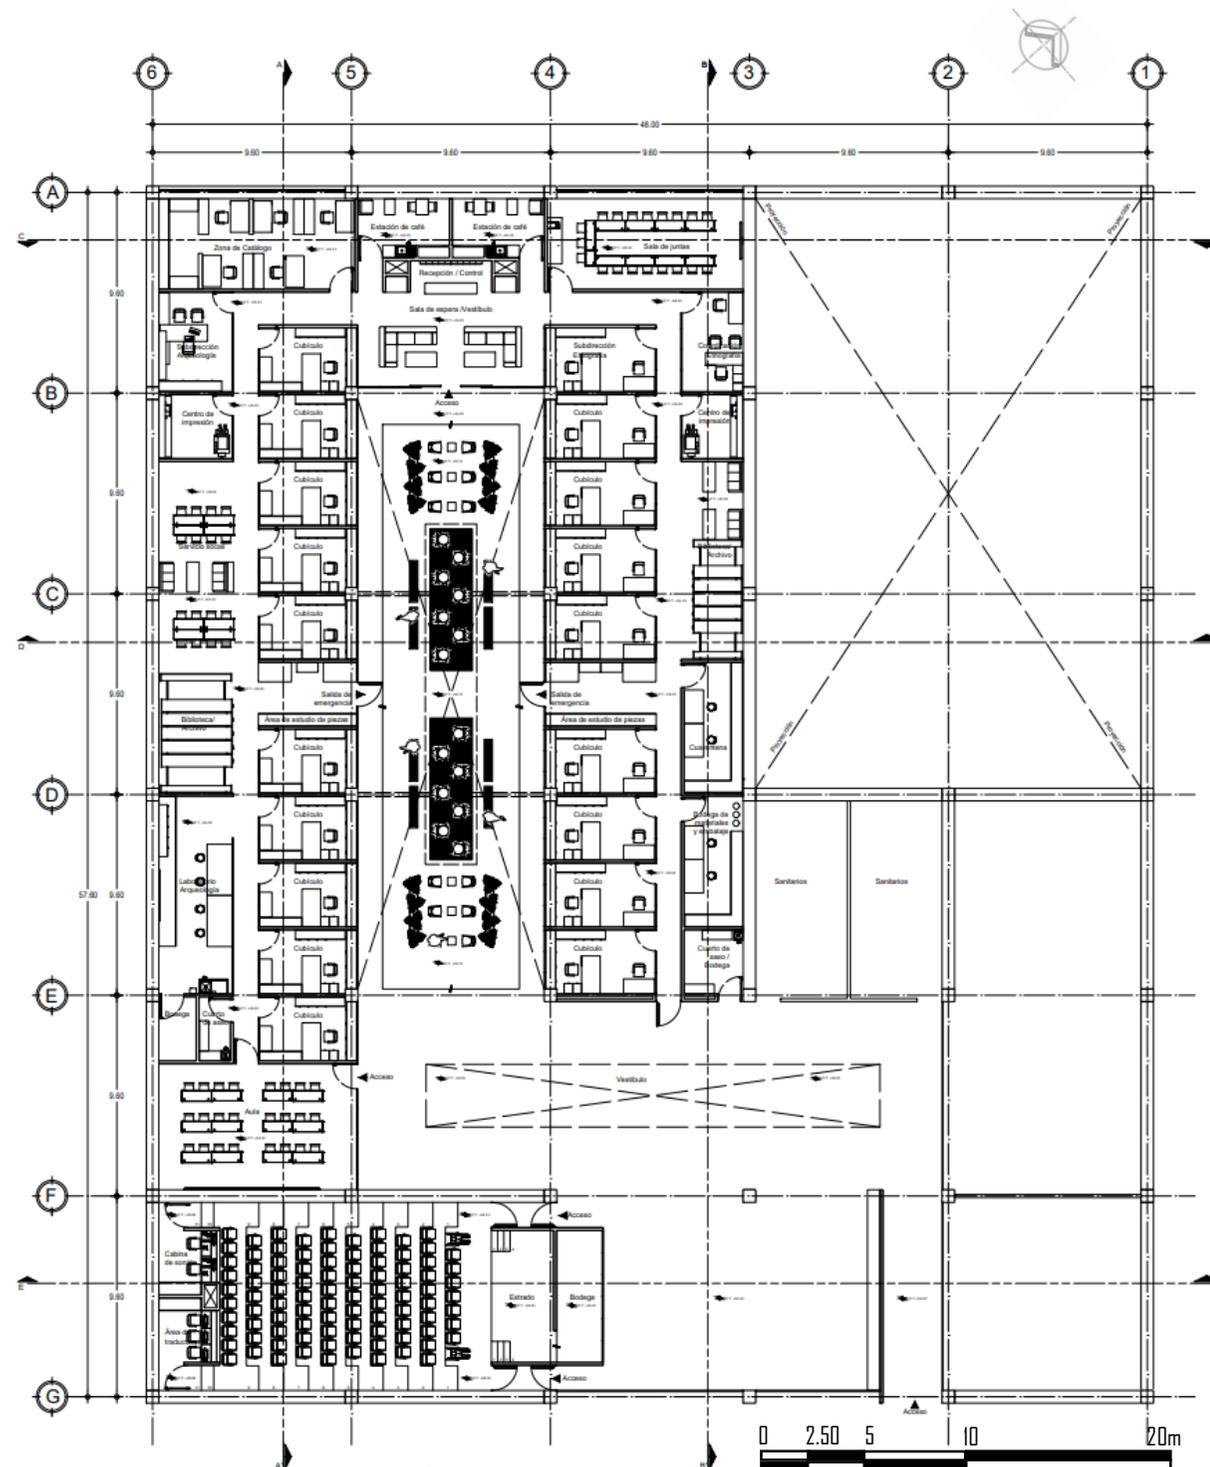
Planta arquitectónica del primer nivel del MNA. Elaboración propia.
